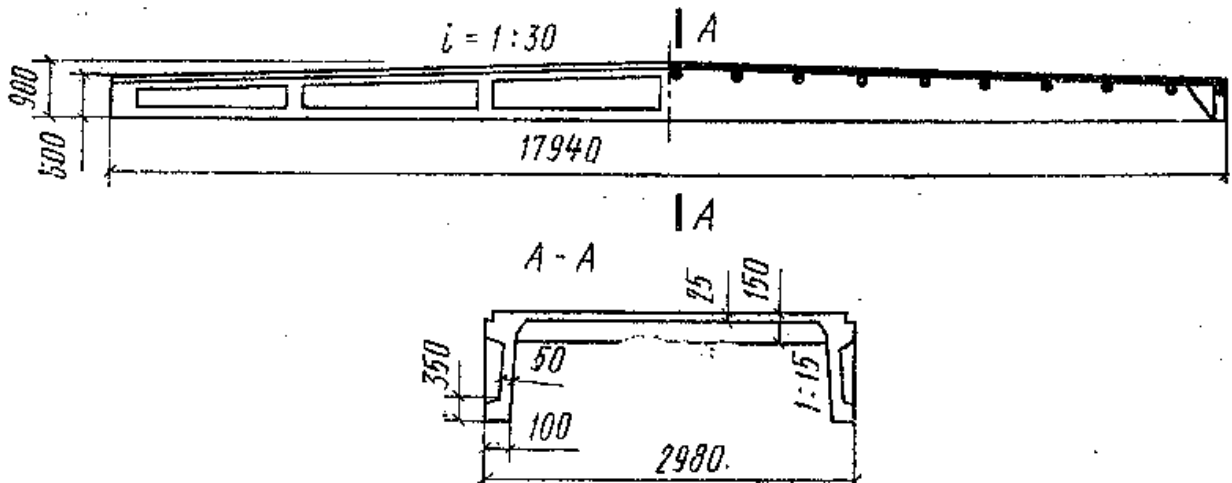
Схема ребристой плиты покрытия под малоуклонную кровлю размером 3x18 м
